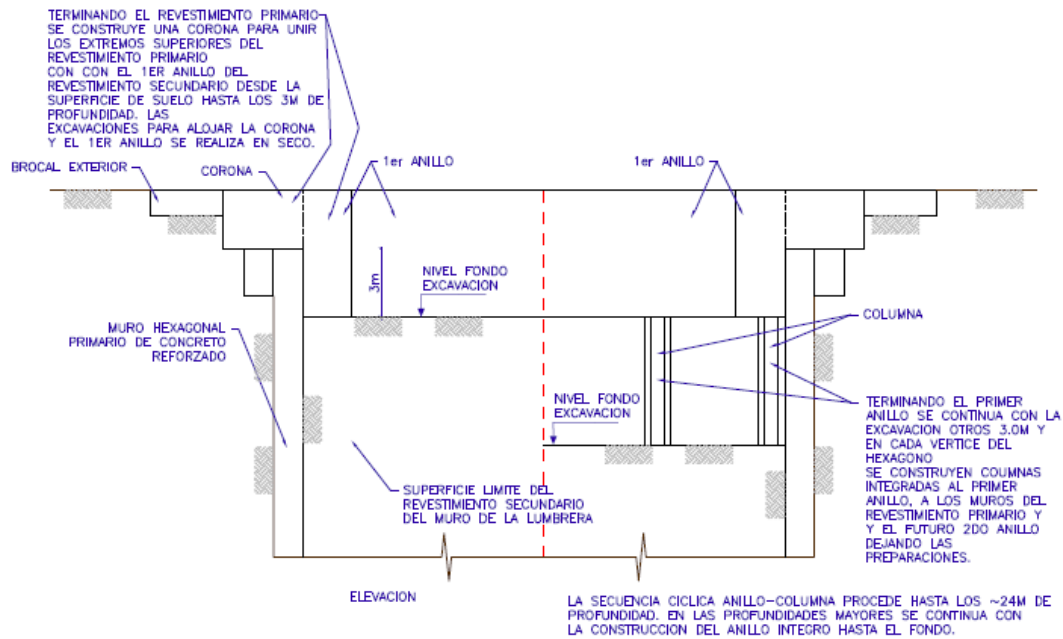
Construcción de columna, primer anillo y primera serie de columnas (Zemva 2011).
